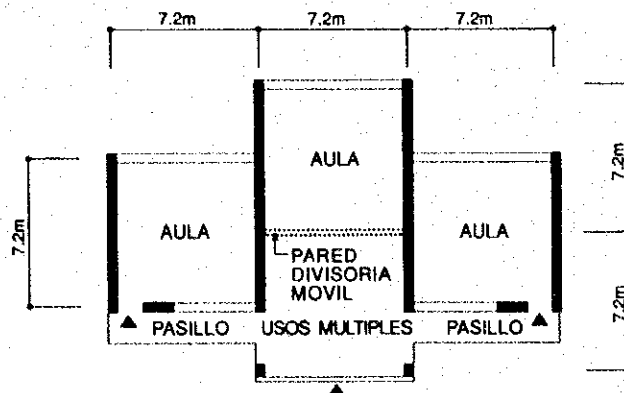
PLANTA DEL EDIFICIO DE AULAS TIPO 3-3-6
